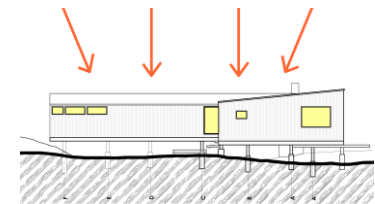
Ingreso del sol por la fachada Oeste. Fuente: Autor.
